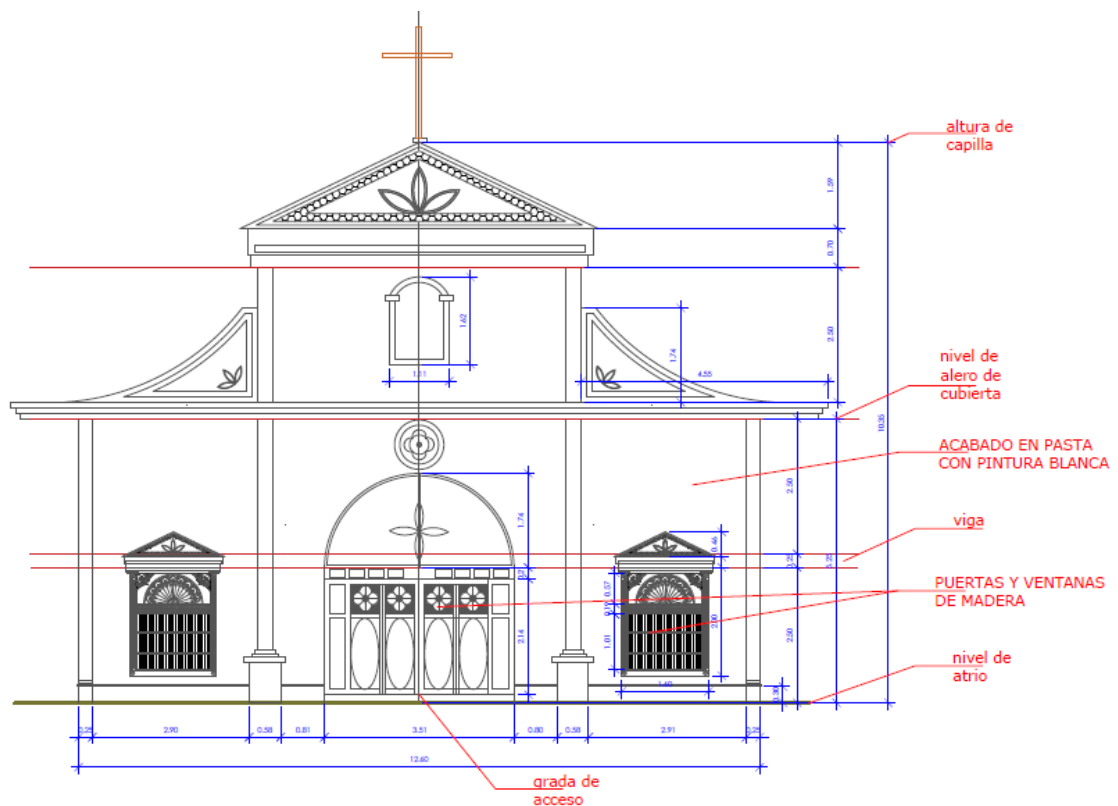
Plano de fachada de proyecto. Fuente : ARQ. Fabián ARIAS
